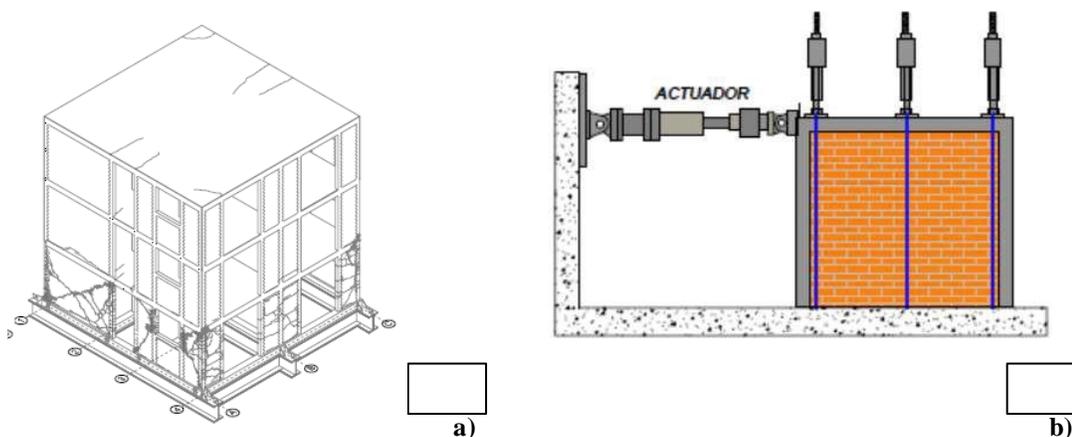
a) Modelo a escala de una estructura de mampostería confinada (Ensayo en mesa vibratoria) (Alcocer et al., 2004). b) Muro de mampostería confinada en ensayo cuasi estático (Zúñiga, 2005)
